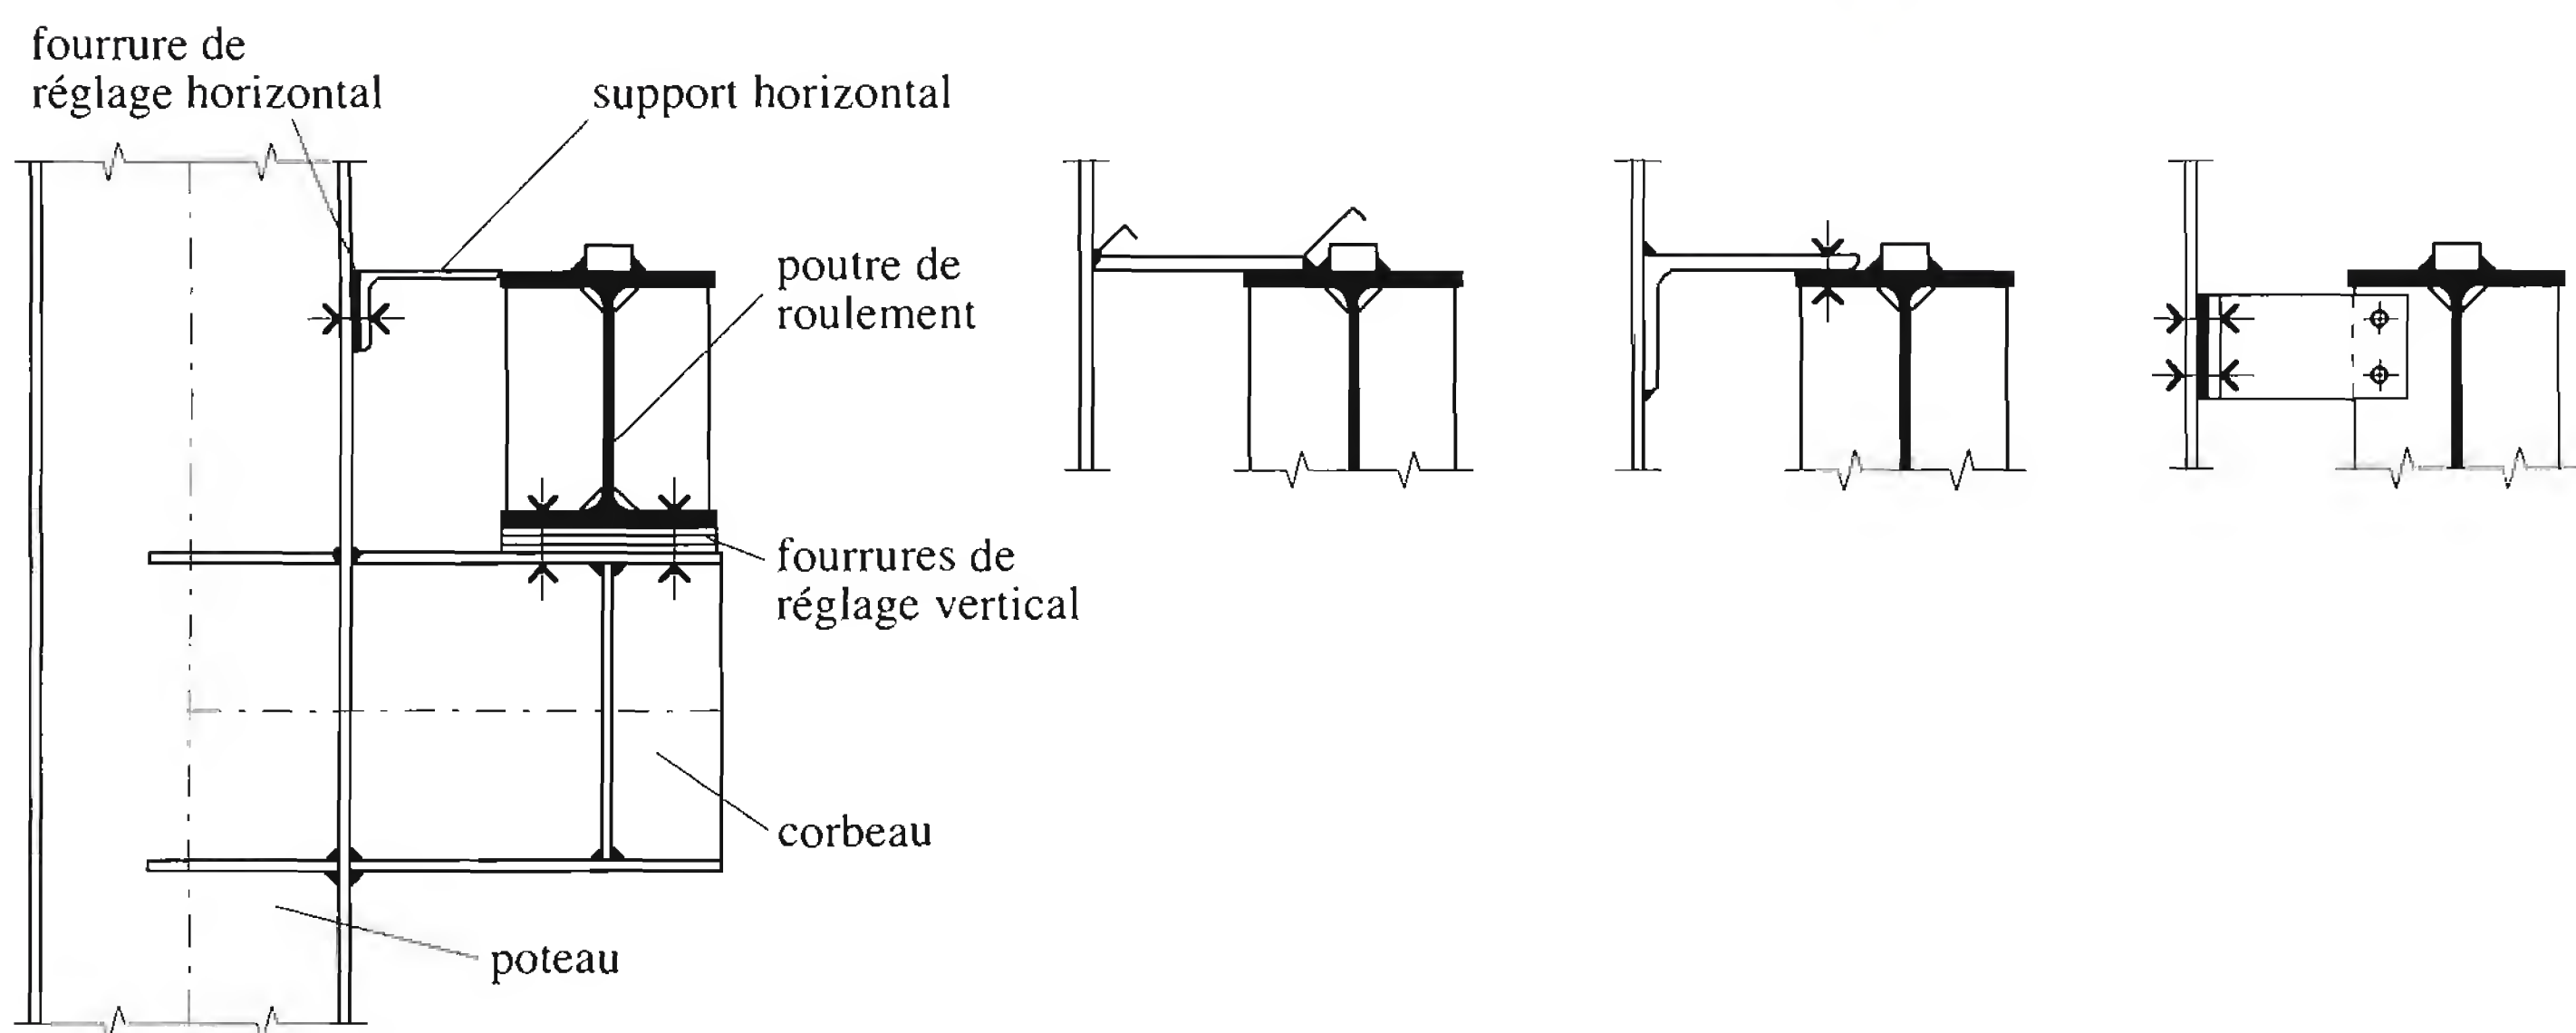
Exemples de supports horizontaux de la poutre de roulement.
